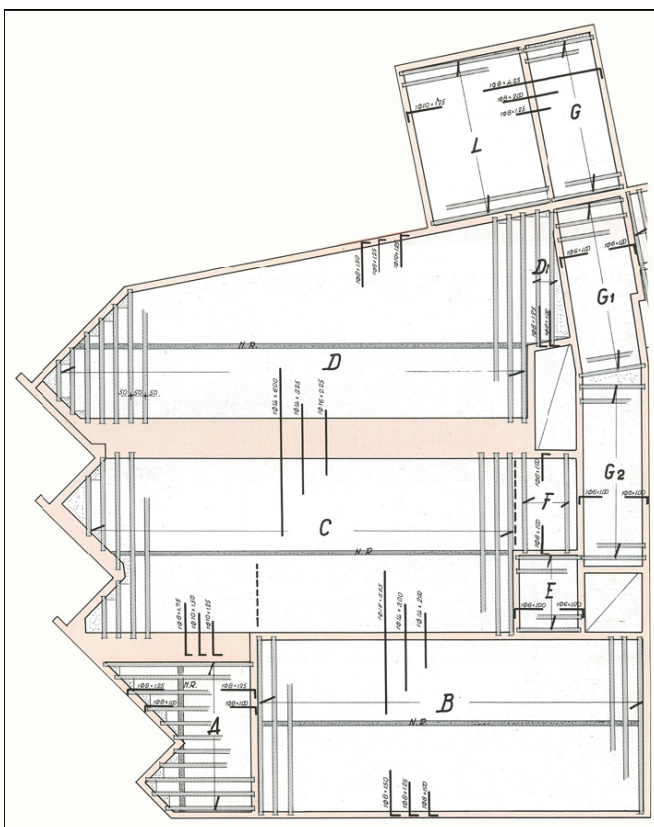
Impiego di solai a travetti in grado di adattarsi agevolmente alla configurazione planimetrica dell'edificio³⁸
